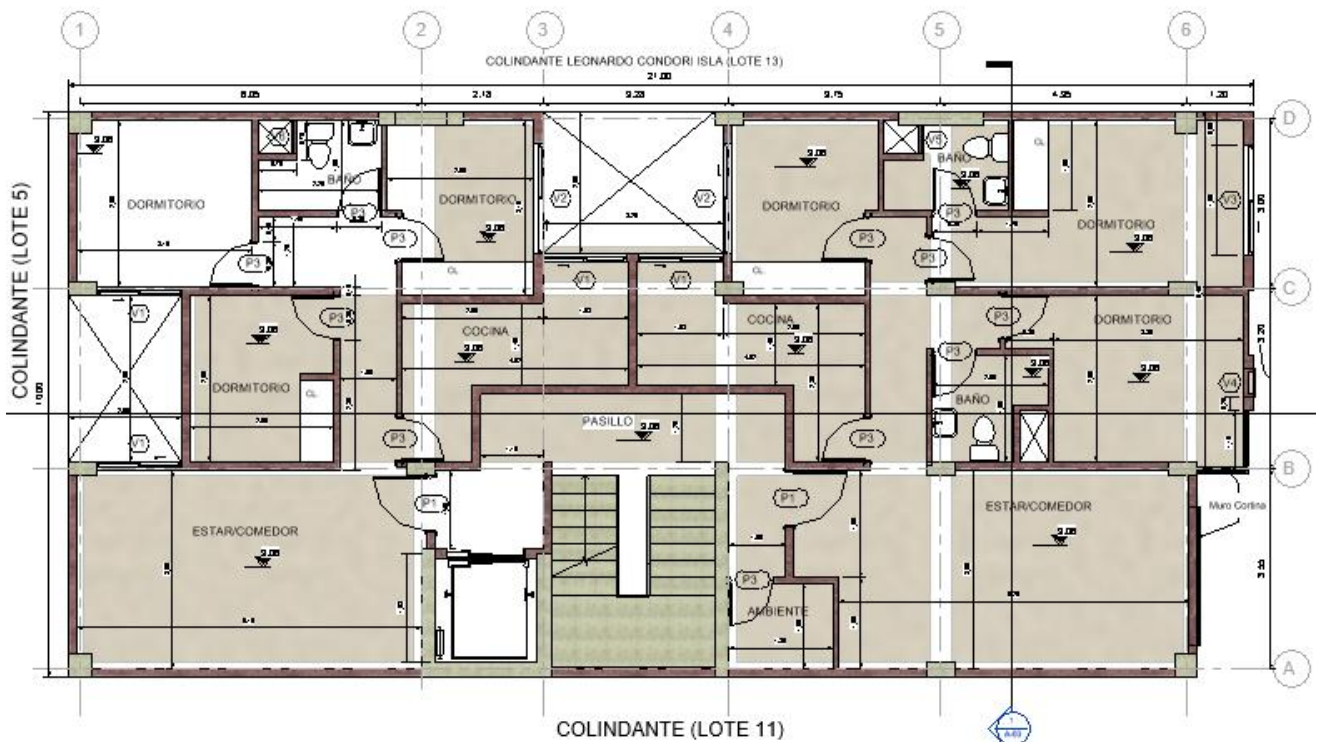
Planta típica arquitectura del edificio realizado en revit 2021
